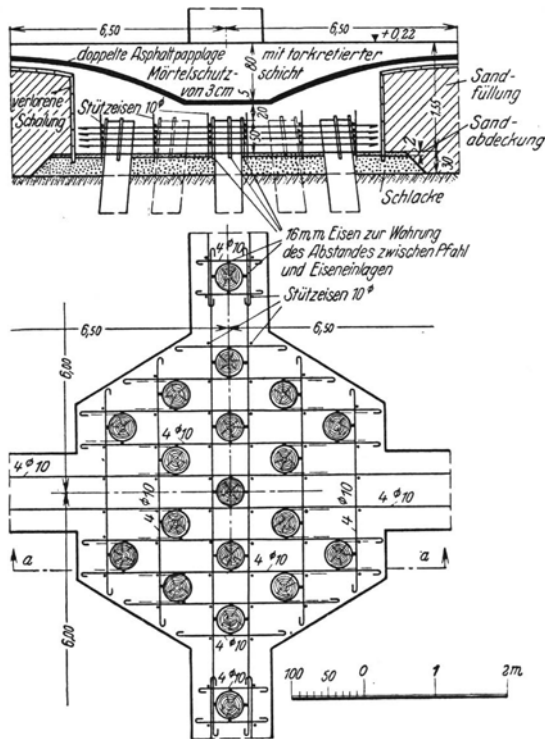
Bewehrung des Pfahlrostes. (Nach Fabricius: Hafenbautechn. Jahrbuch 1928/29 S. 74.)
